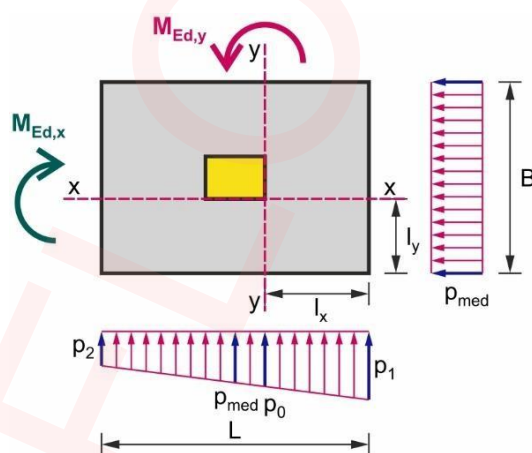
Schema de calcul a momentelor încovoietoare în secțiunile x-x și y-y
